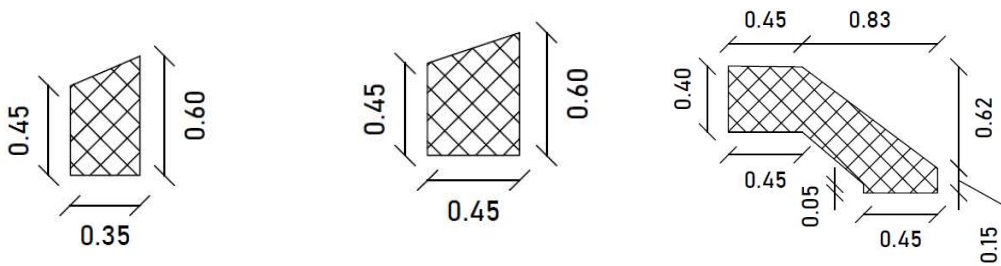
Da sinistra. Sezione A, B e C dei pilastri
